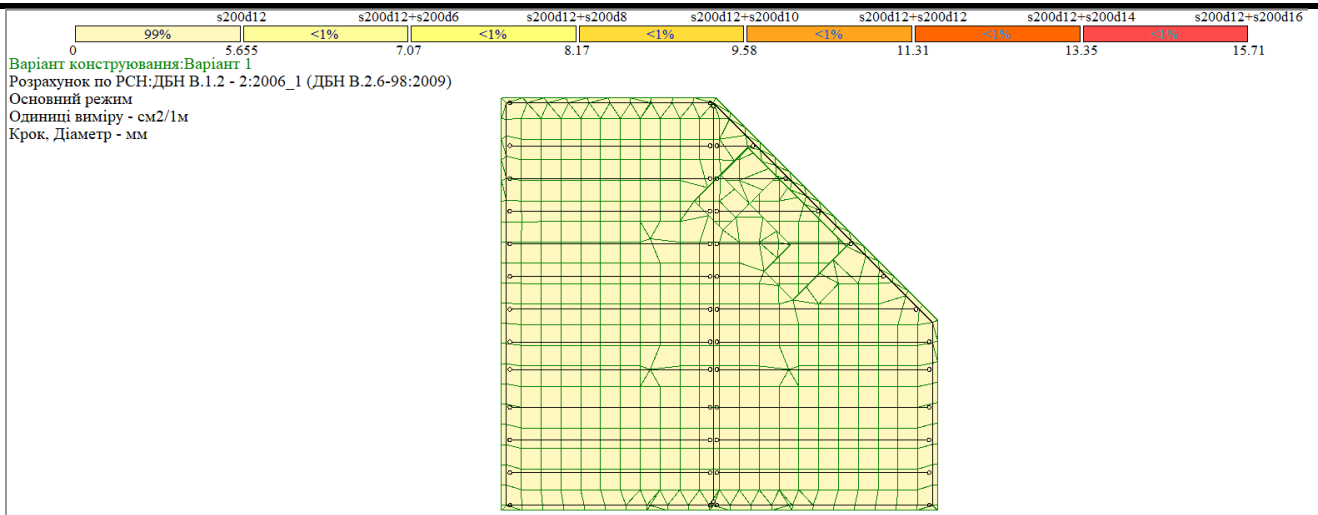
Площа арматури на 1 м. п. по осі x (нижня грань)
